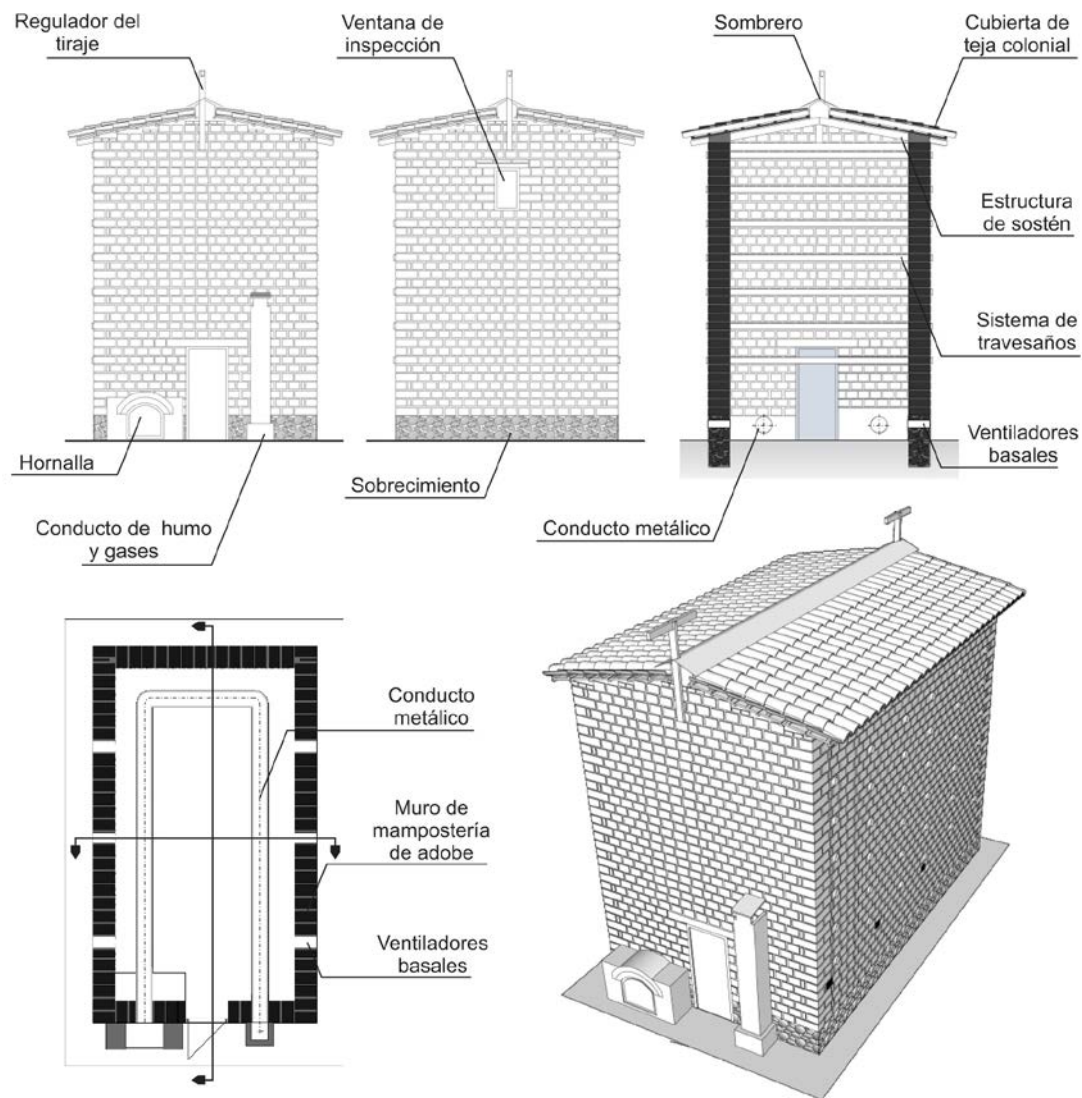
Planta, corte, vistas y perspectiva de una estufa. Fuente: Elaboración propia.
